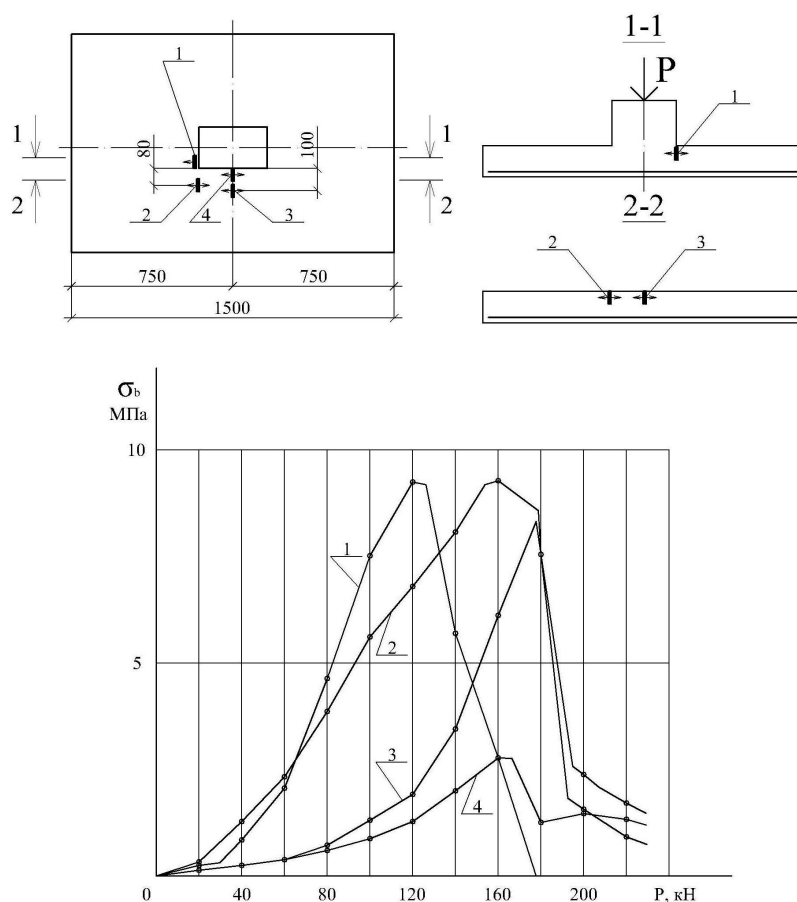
Зависимость напряжений в сжатой зоне бетона плиты фундамента Ф-3-2 от уровня внешней нагрузки
